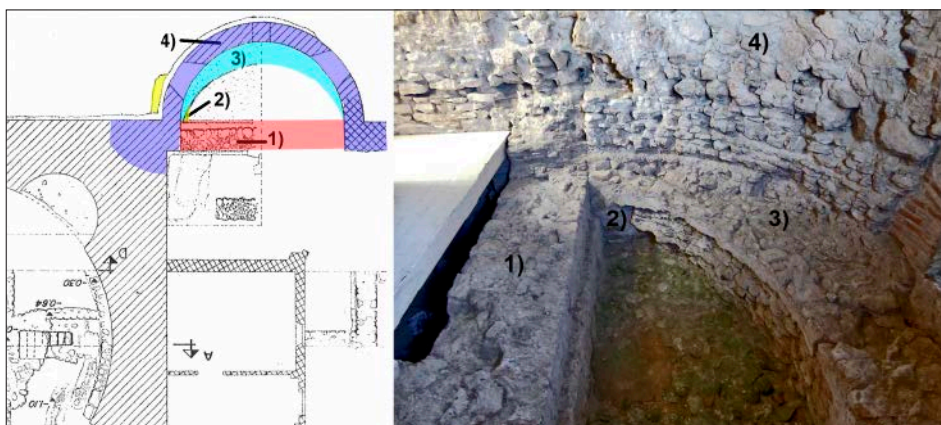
Planta y fotografía de las diferentes fases constructivas detectadas en la zona del ábside.
